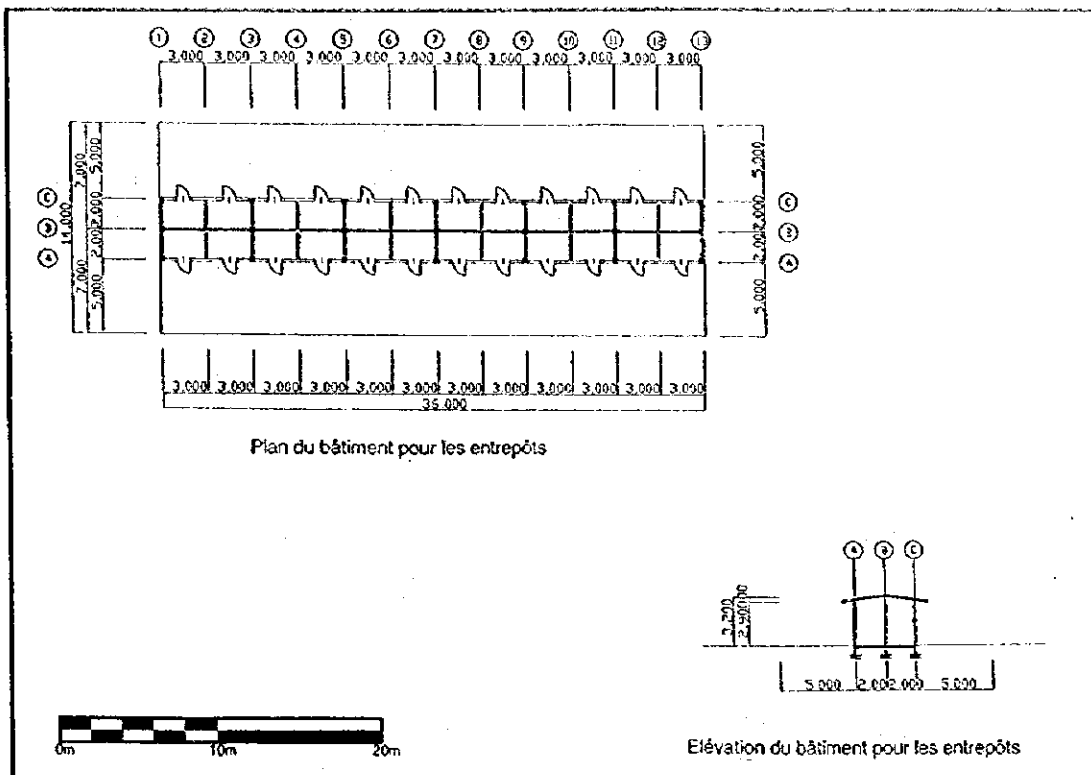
Plan et élévation des entrepôts pour les engins de pêche
